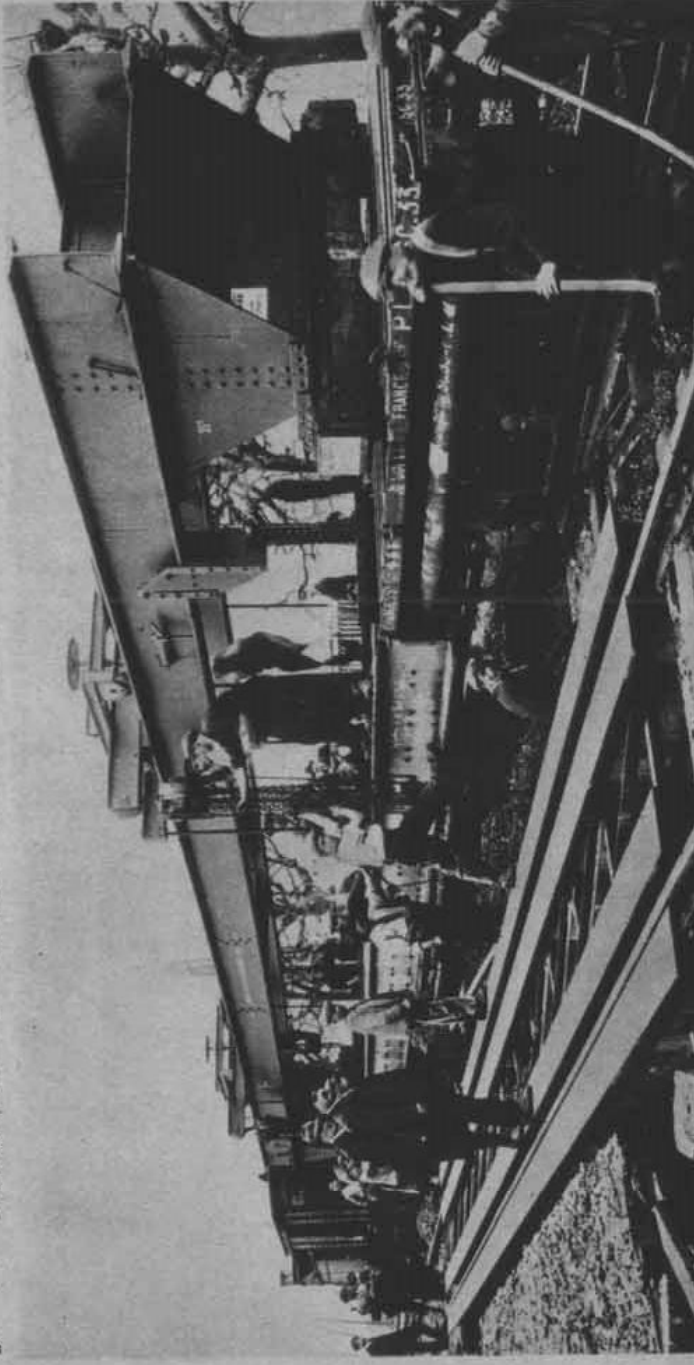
Descente d'un tablier auxiliaire sur ses calages (au premier plan, à gauche, un tablier auxiliaire en place).
